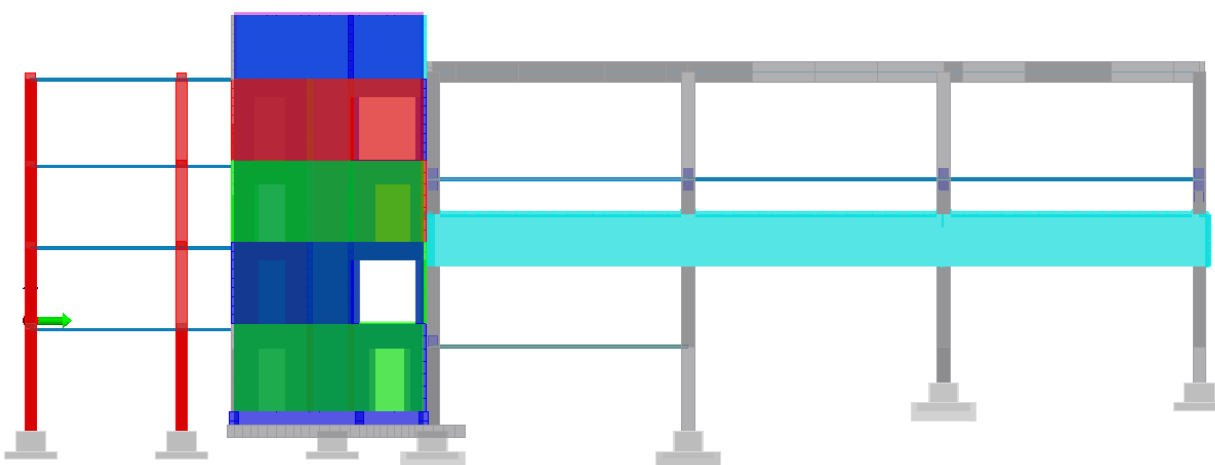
Vista degli elementi strutturali, prospetto SUD - Modello FEM
